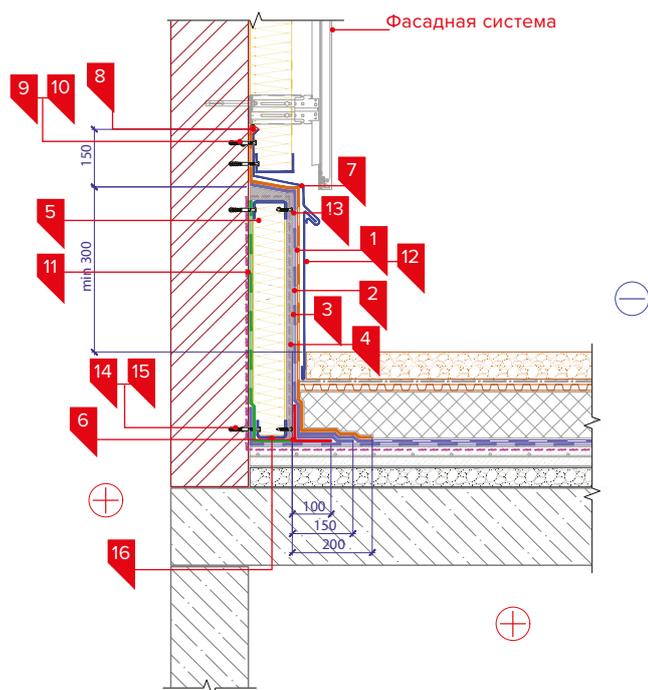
Вариант заведения пароизоляционного слоя к утепленным вертикальным конструкциям
